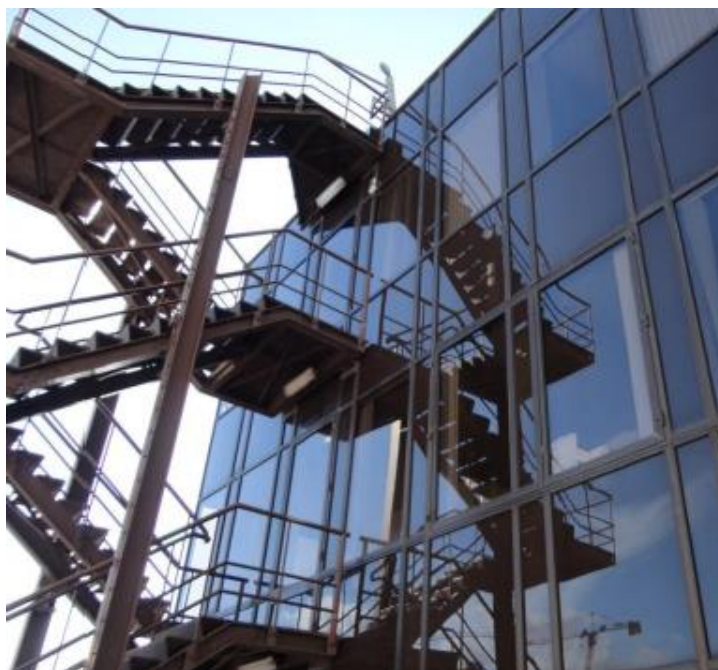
Vista da fachada de Nordeste (Reservado, 2016)
